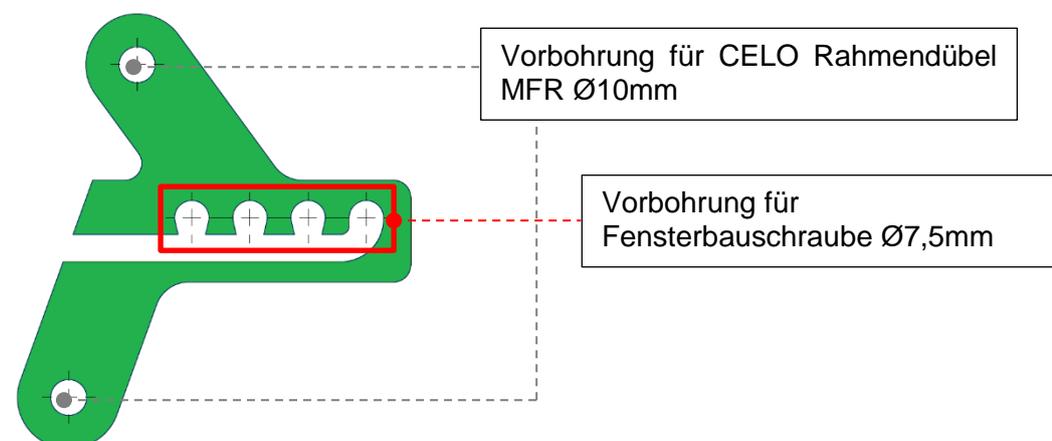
Darstellung „Fenstersicherung ProtecFIX“
